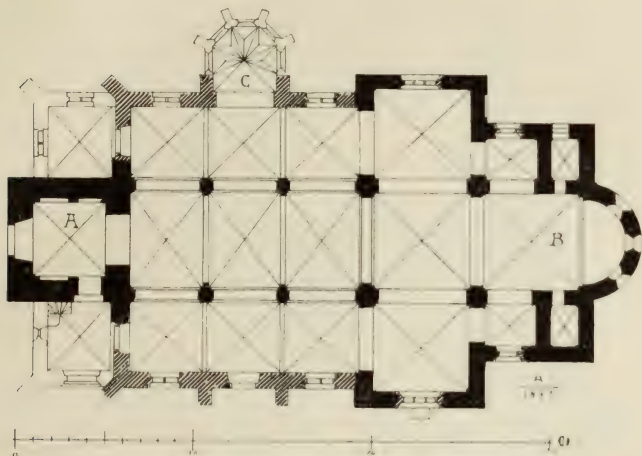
Bergheim Grundriss der katholischen Pfarrkirche
